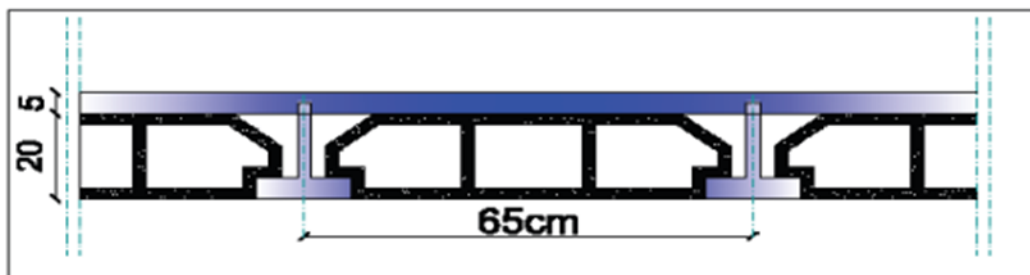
Plancher en corps creux : (20+5 cm)
